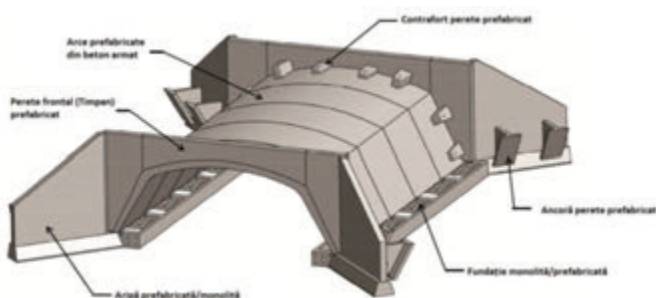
Pod prefabricat îngropat din beton armat – CON/SPAN®
